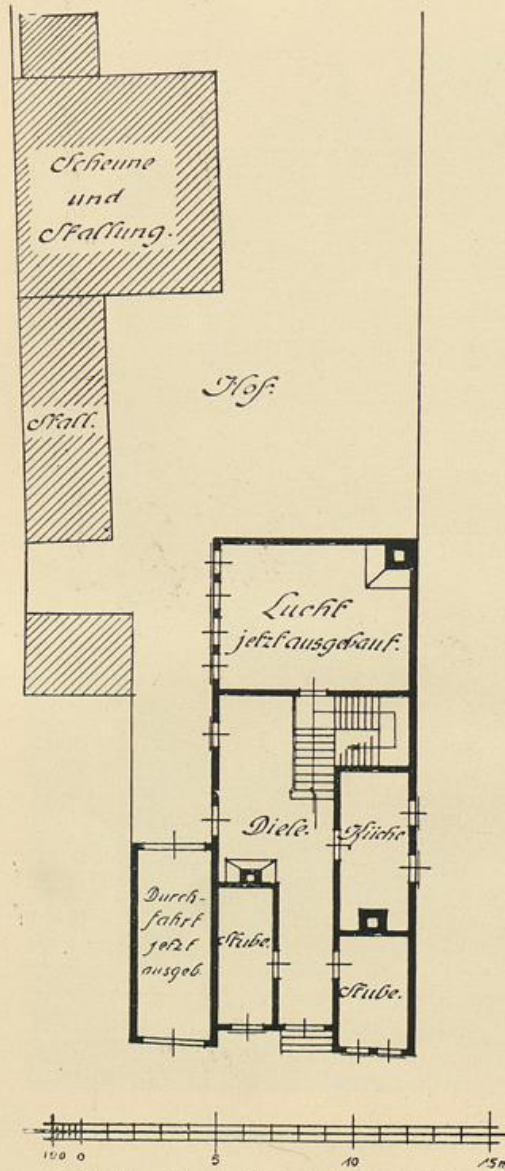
Hameln, Baustraße 7, erbaut 1609.
